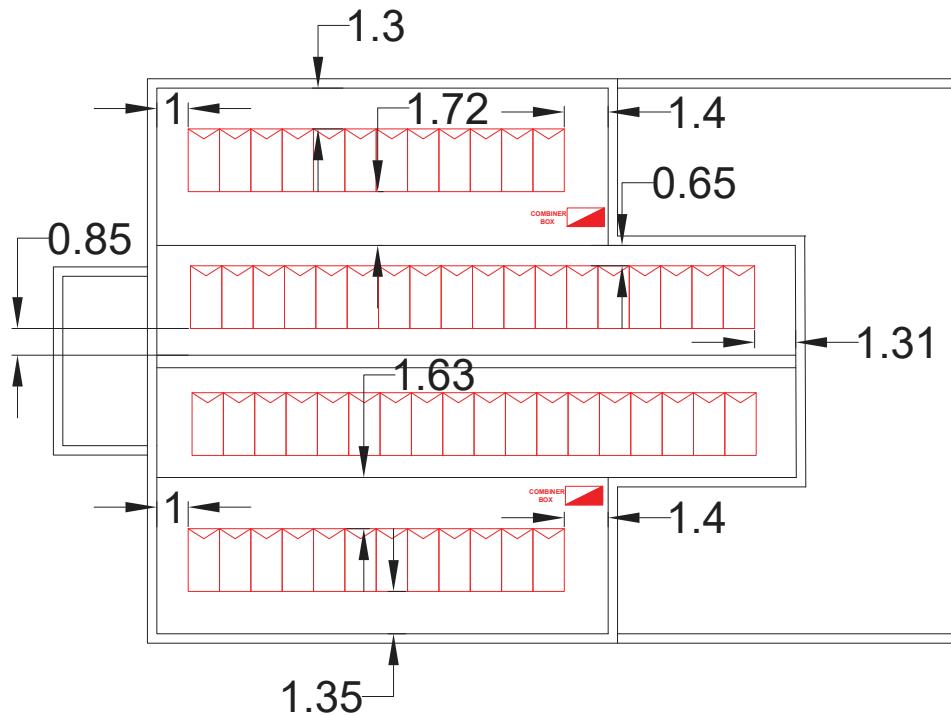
Distribución del SFV a instalar en el techo del edificio.
